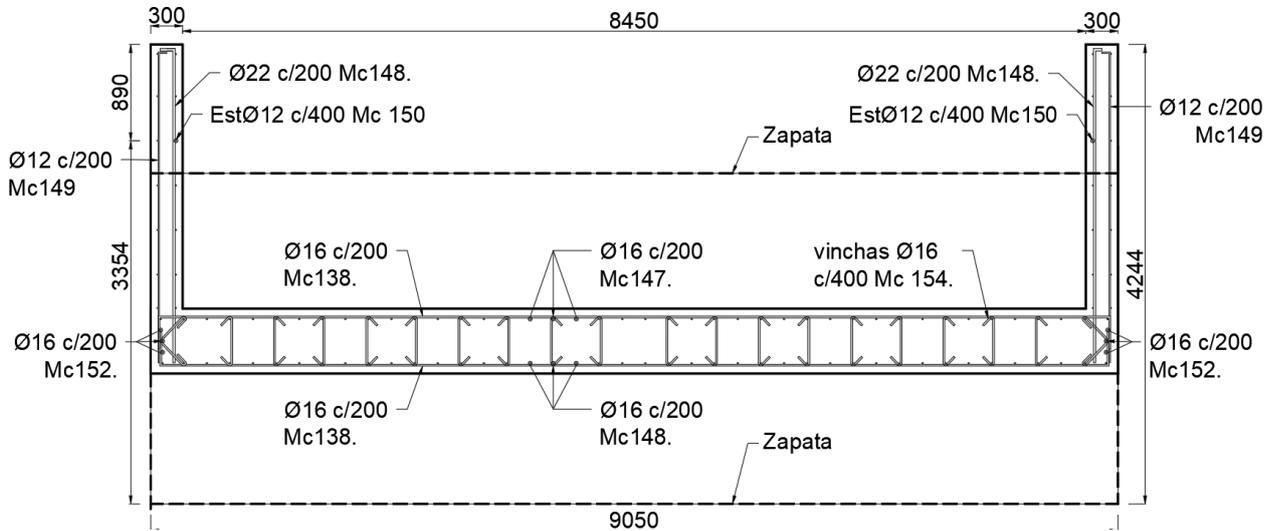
Vista en planta del estribo 1 [Elaboración propia]
